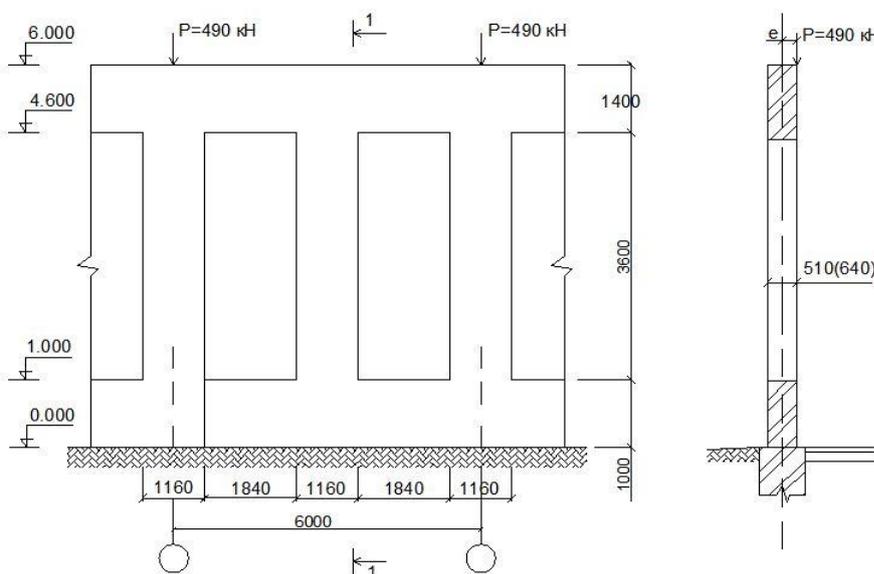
К расчету простенка одноэтажного производственного здания
